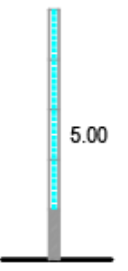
Prospetto delle barriere trasparenti da 5 metri
